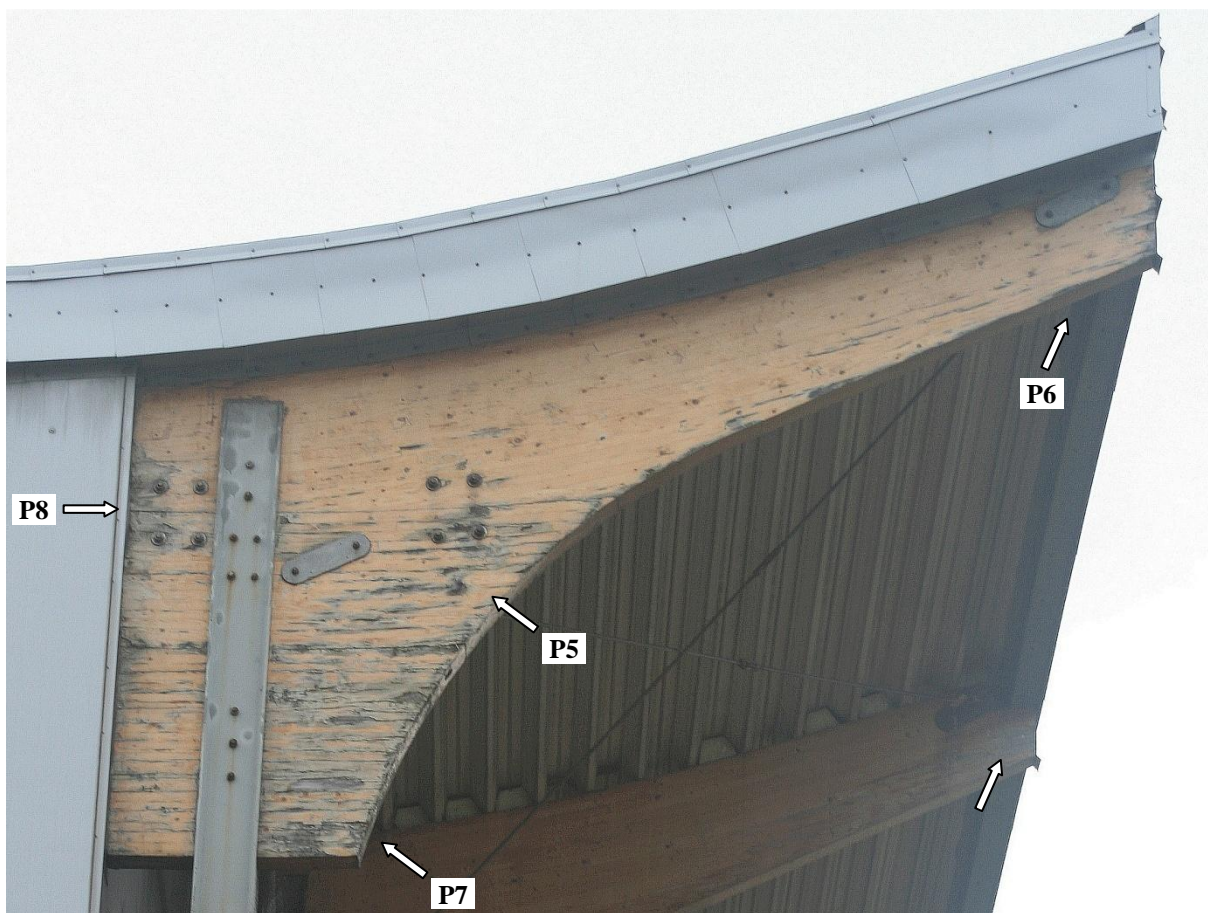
Stan zewnętrznych części dźwigarów od strony wschodniej
